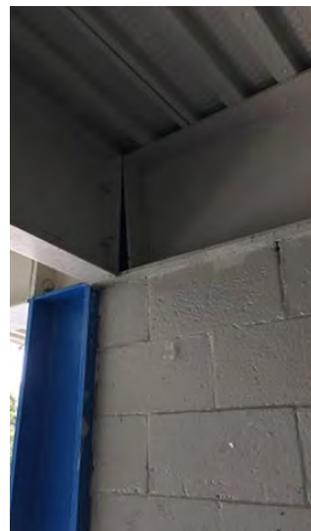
Conexiones excéntricas viga-columna en estructuras metálicas.
